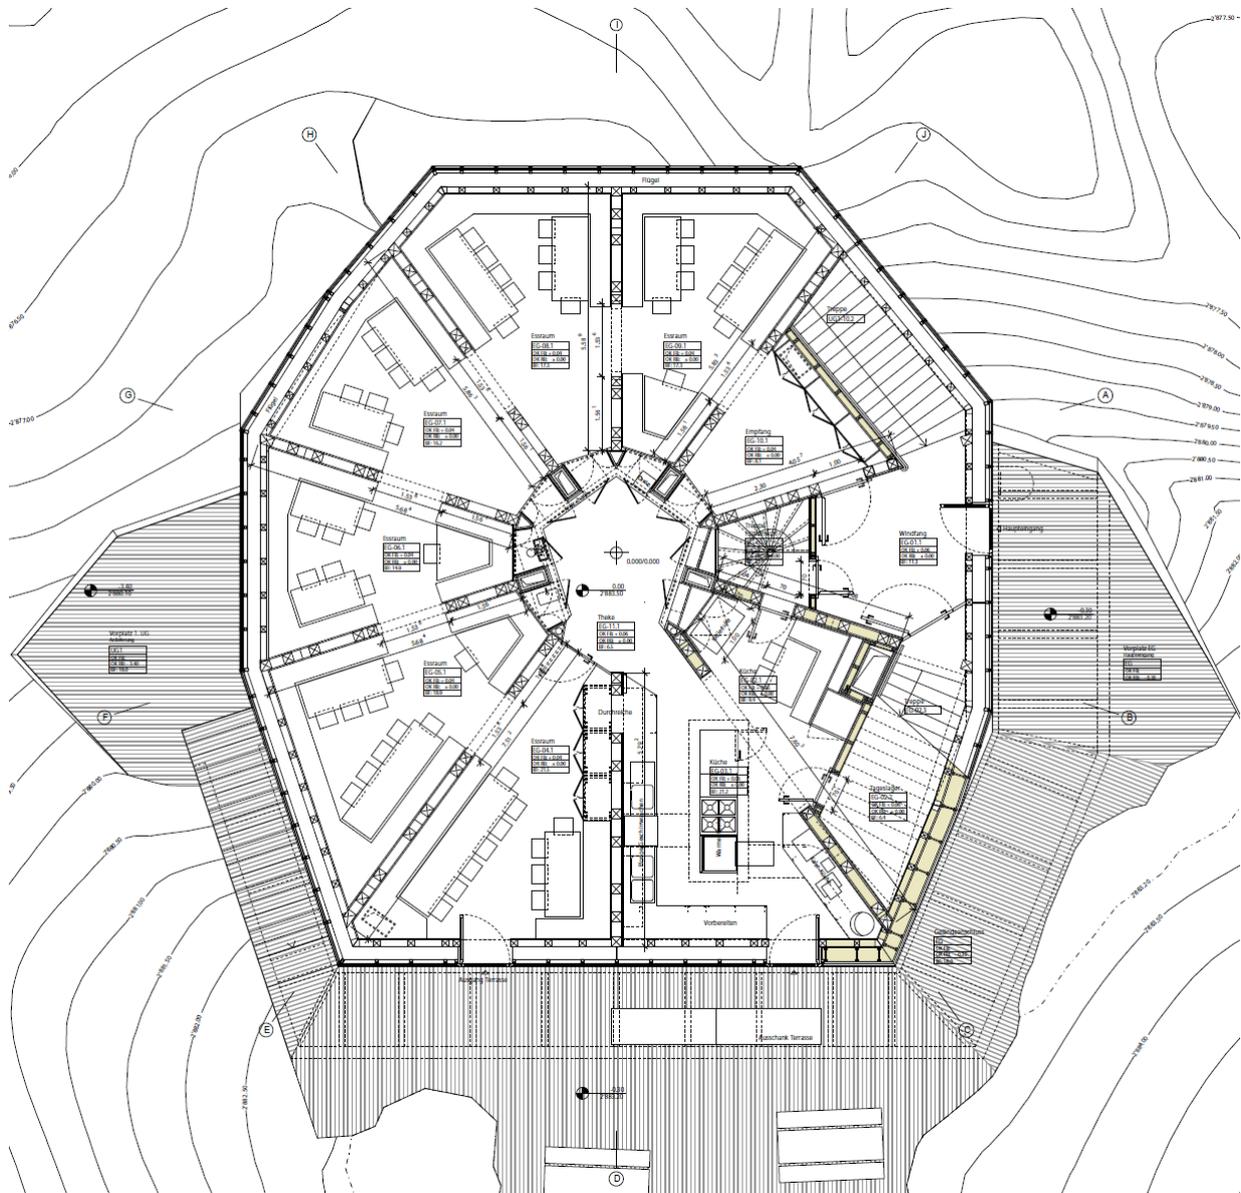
Erdgeschoss (Empfang, Restaurant, Küche) mit Umgebung
